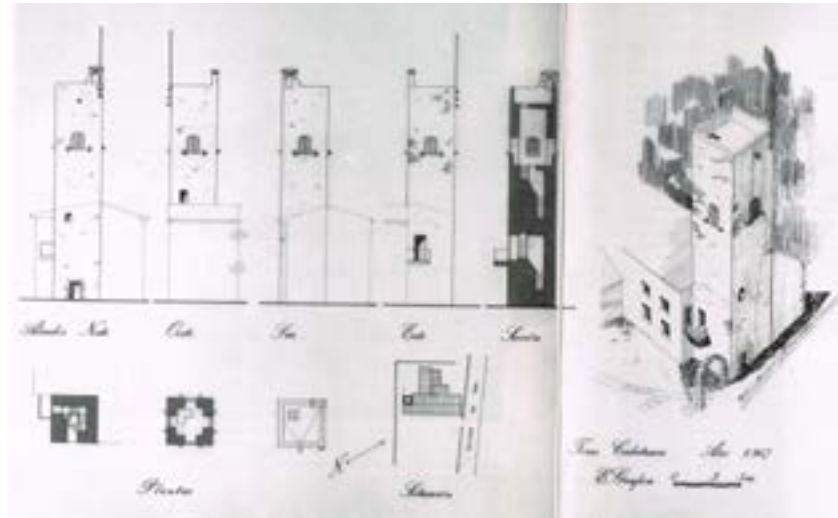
Planta y alzados laterales de la torre de Calatrava. Fuente: Mesado, 1990
